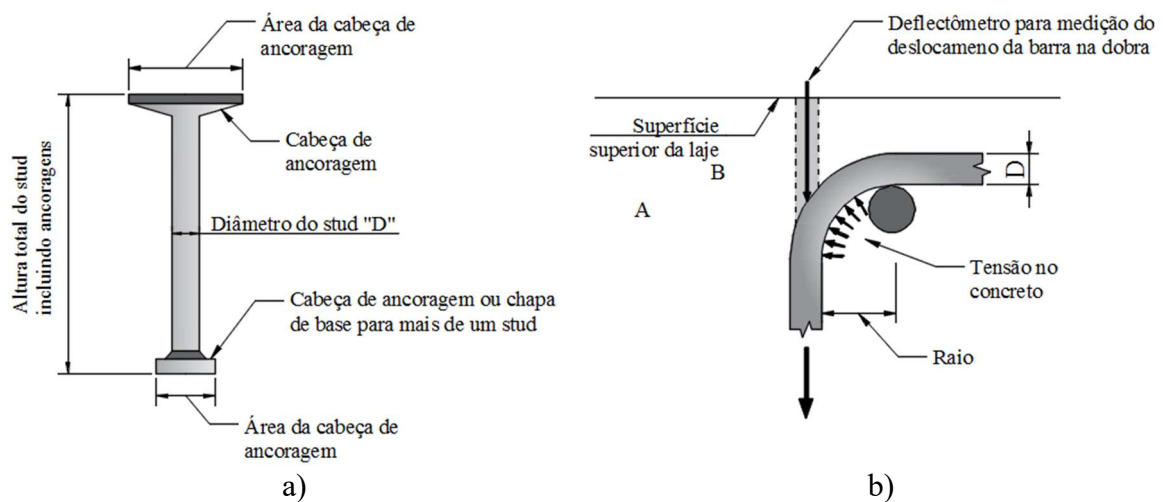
Armaduras de cisalhamento para lajes lisas (ACI 421.1R, 1999)
